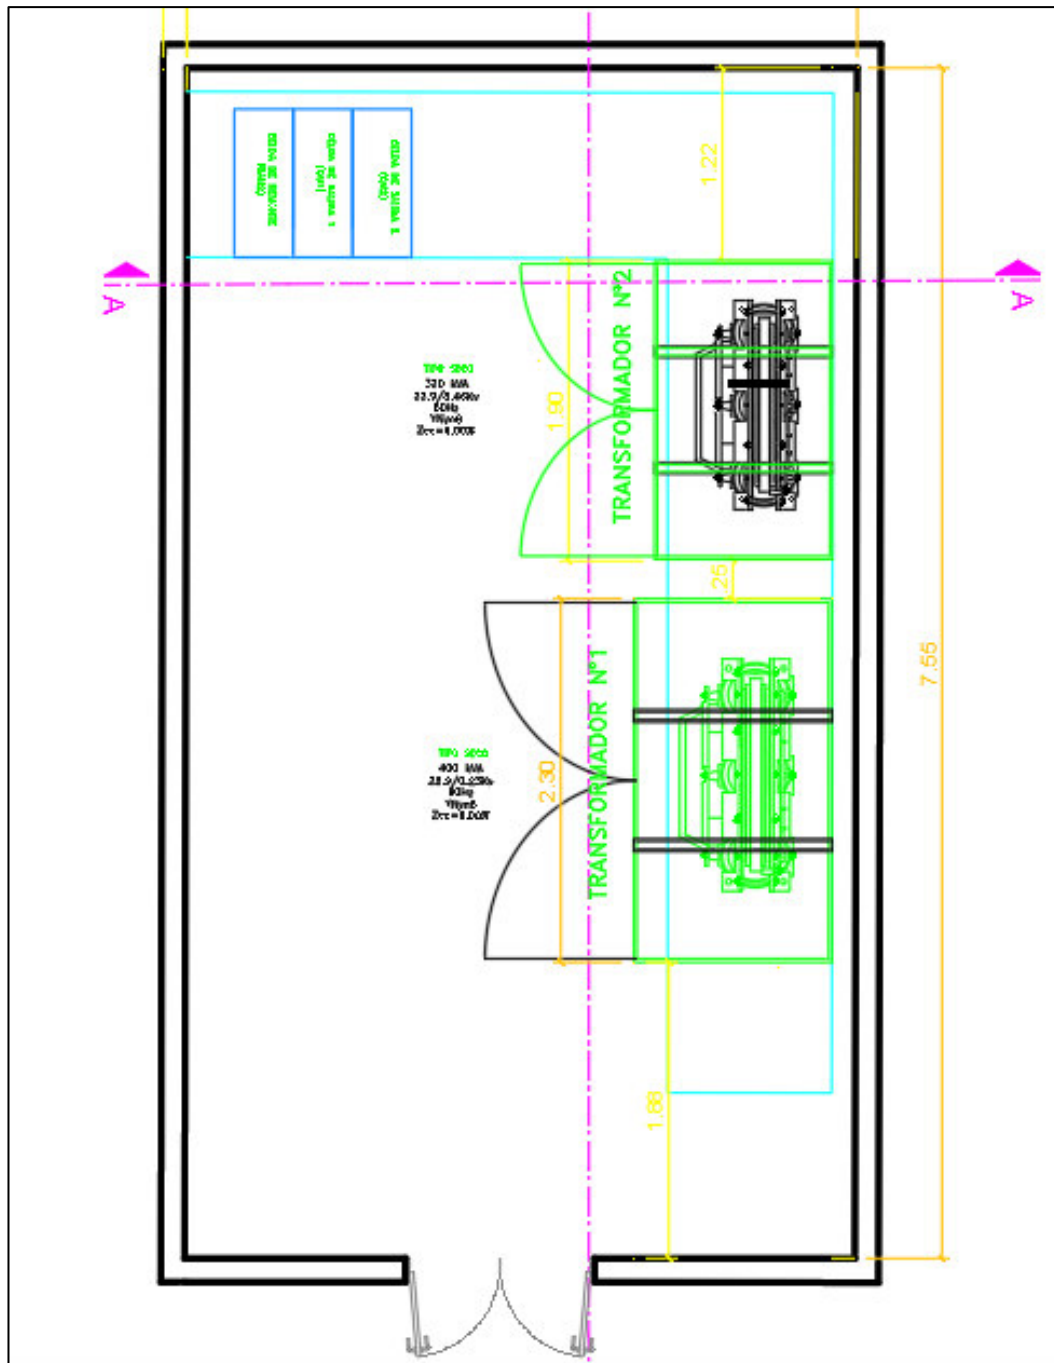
Distribución inicial de proyecto de subestación N°2. Fuente: Elaboración: Daca.
